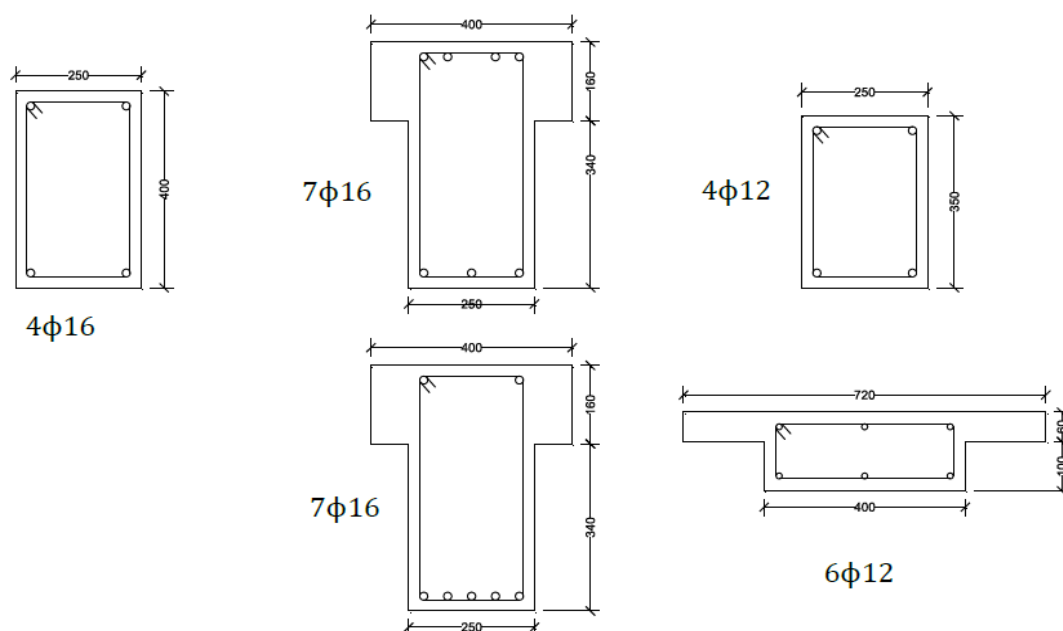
Secções transversais dos elementos típicos da estrutura (a) pilares, (b) vigas na direção X e (c) vigas na direção Y.
